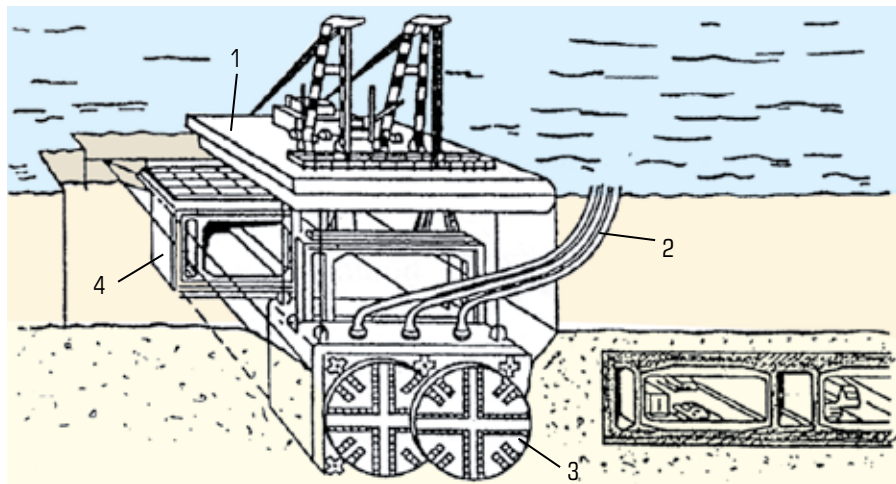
Схема разработки подводной траншеи щитовым рабочим органом (проект):
